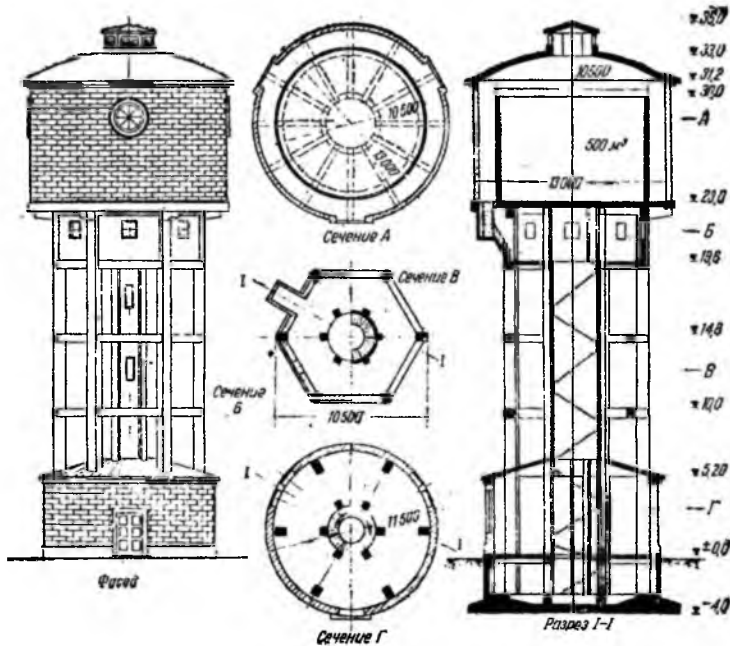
Водонапорная башня с железобетонным баком с плоским дном
